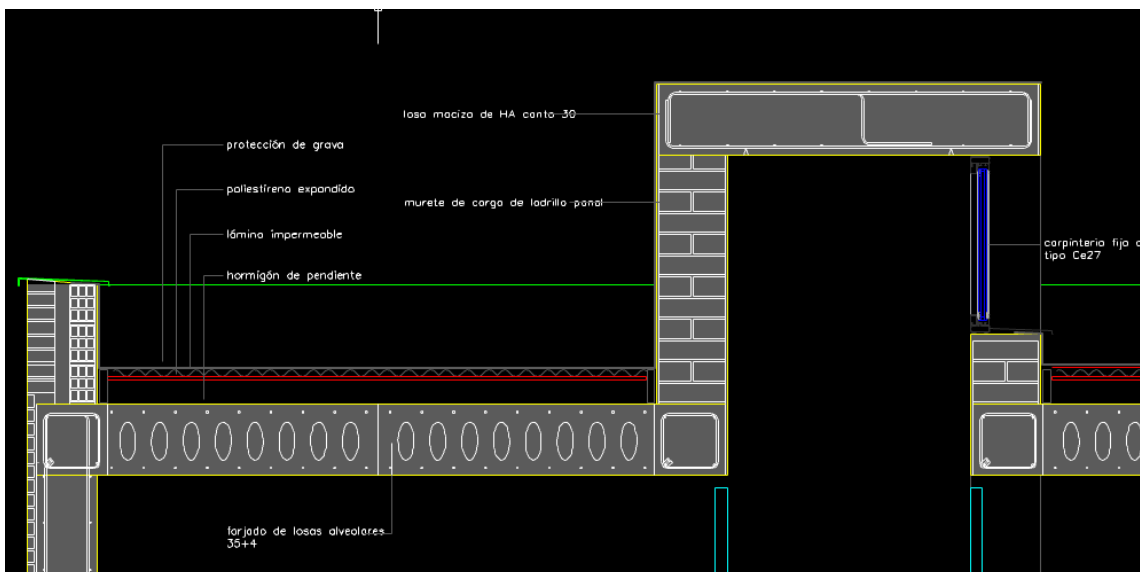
Cubierta en sala multi-usos, obtenido del proyecto de ejecución.
